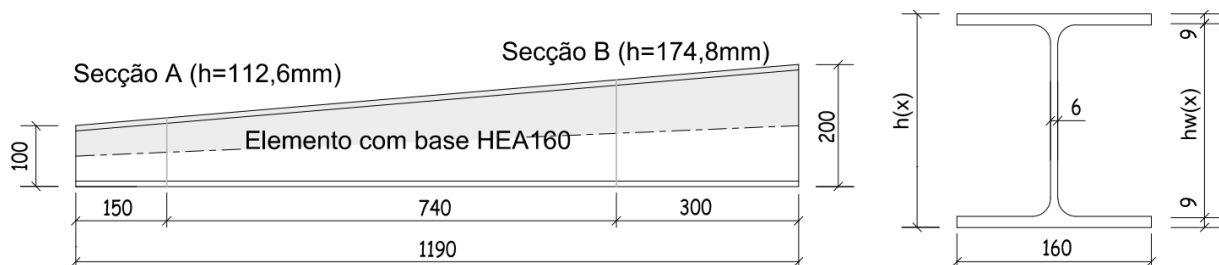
Configuração geométrica do elemento de laminação, corte e soldadura na análise de tensões residuais (dimensões em mm).
